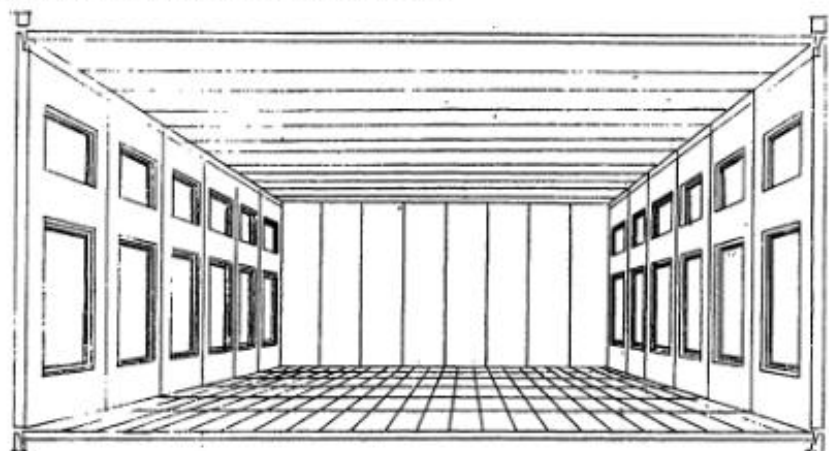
Интерьер двухсветного залых помещения без промежуточных опор
